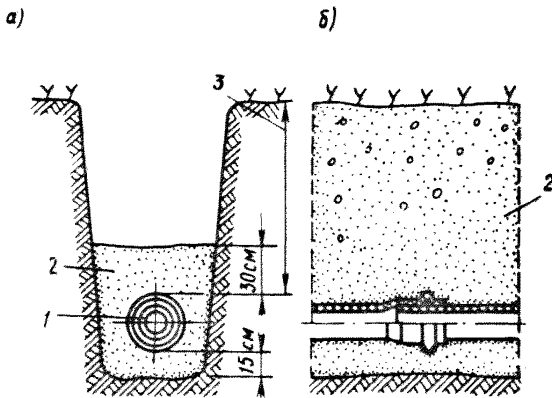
Засыпка грунтом поливинилхлоридного трубопровода после гидравлических испытаний
